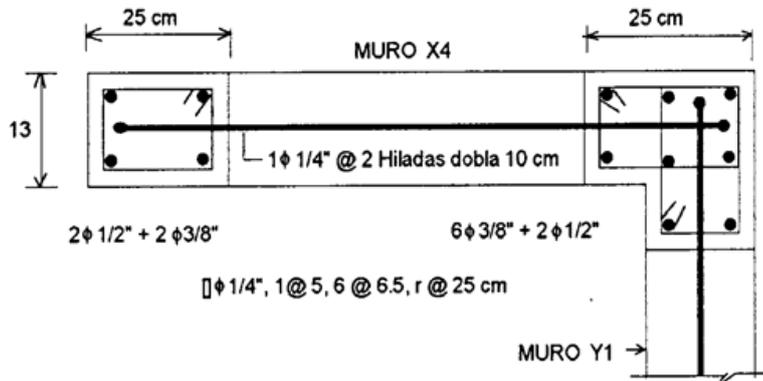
Vista de muros confinados que se interceptan perpendicularmente
